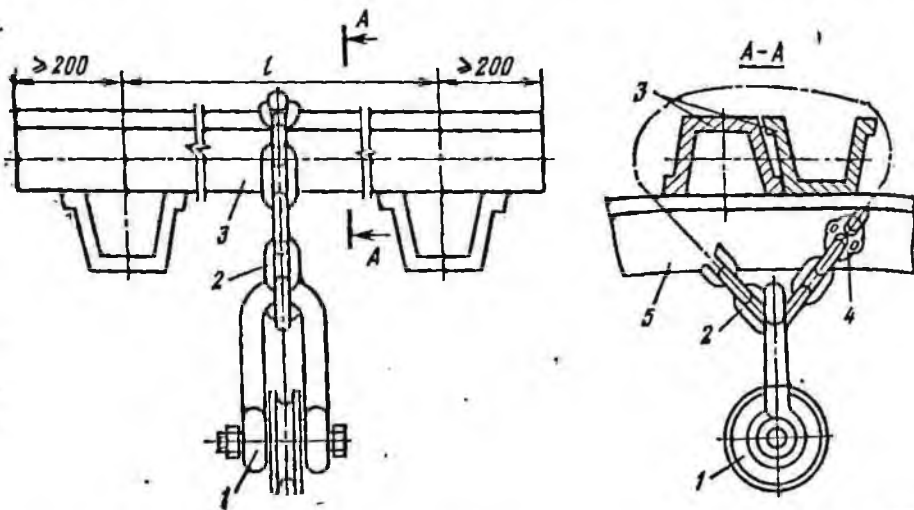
Схема подвески монтажного блока на закладные балки из спецпрофиля: 1—блок грузоподъемностью 5 т; 2—цепь калиброванная ($d=23$ мм, $t=84$ мм); 3—желобчатый парный спецпрофиль СП18А или СП28А; 4—соединительное звено ЗС2300Г для цепи ($d=23$ мм, $t=84$ мм); 5—верхняк арочной крепи
